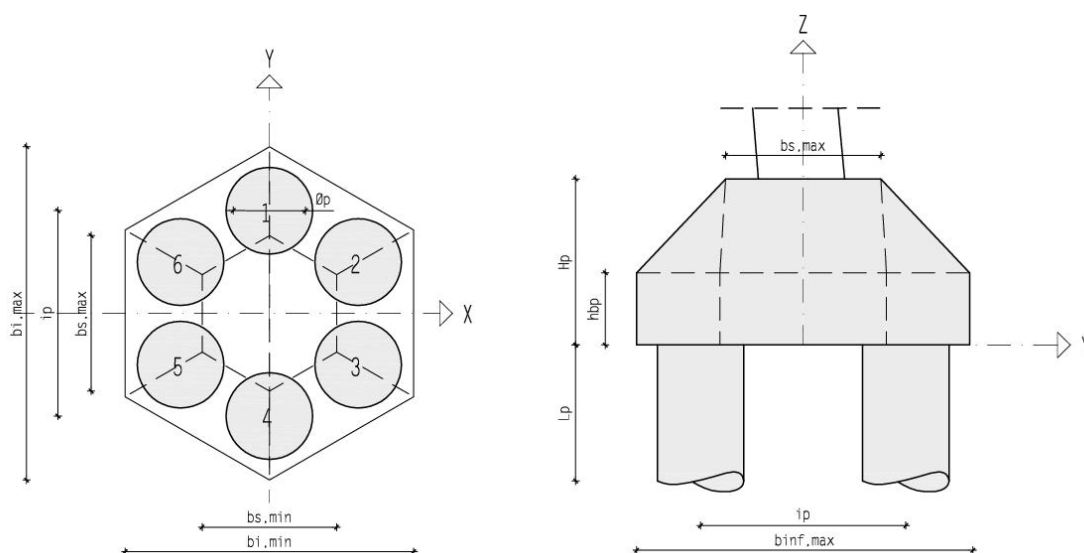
Pianta e sezione della fondazione dell'antenna
